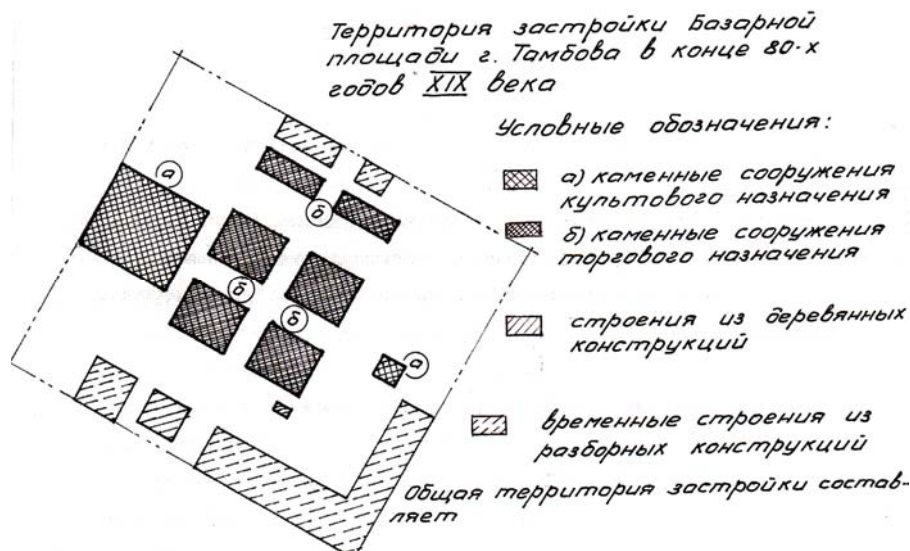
Реконструкция карты-схемы Базарной площади на основе плана 80-х годов XIX века
